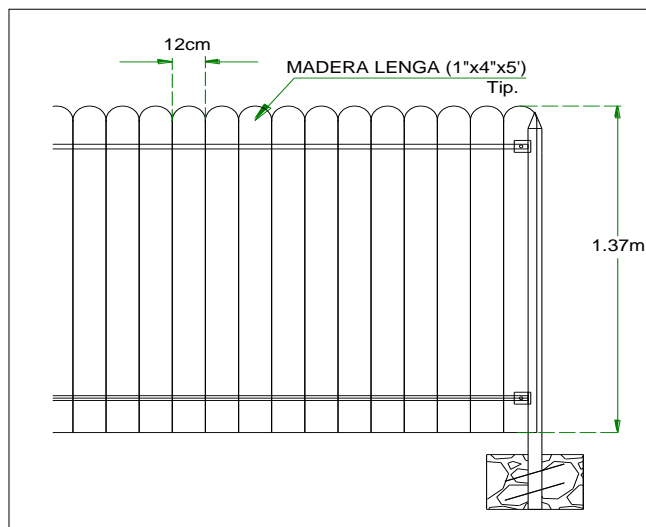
Detalle Perfiles Cerco Acero – Madera Fuente Propia
